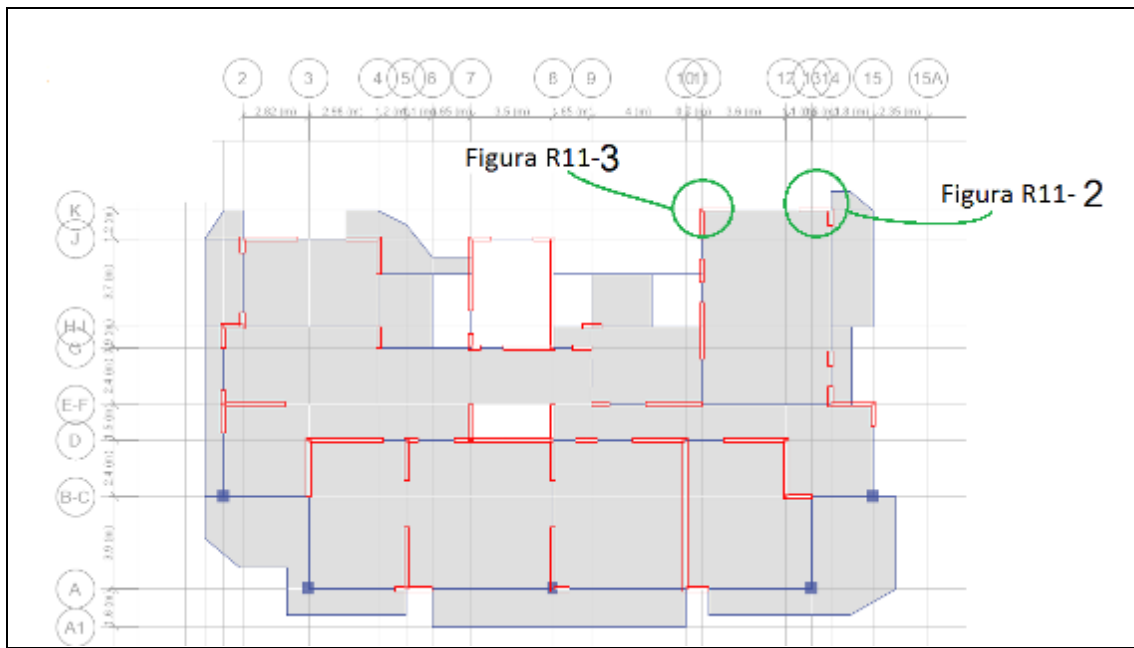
Planta del subterráneo del edificio R11, se indican los elementos dañados
